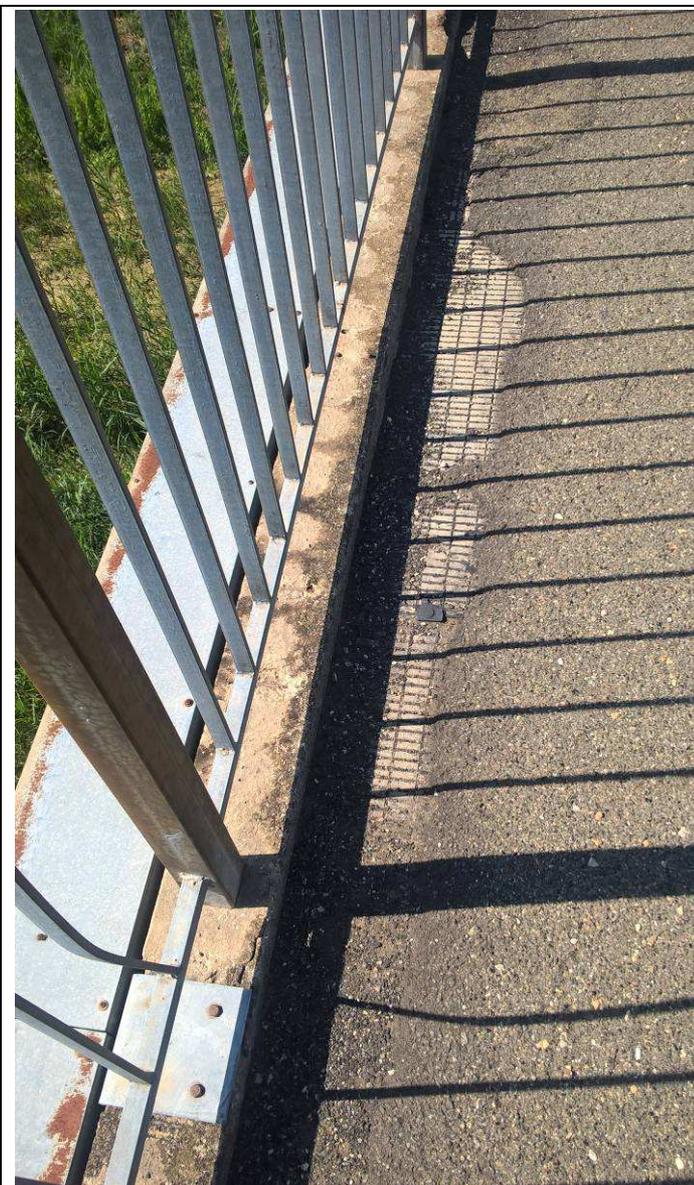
Dettaglio della pavimentazione dell'impalcato e della canaletta porta impianti posta in affiancamento al lato di valle
